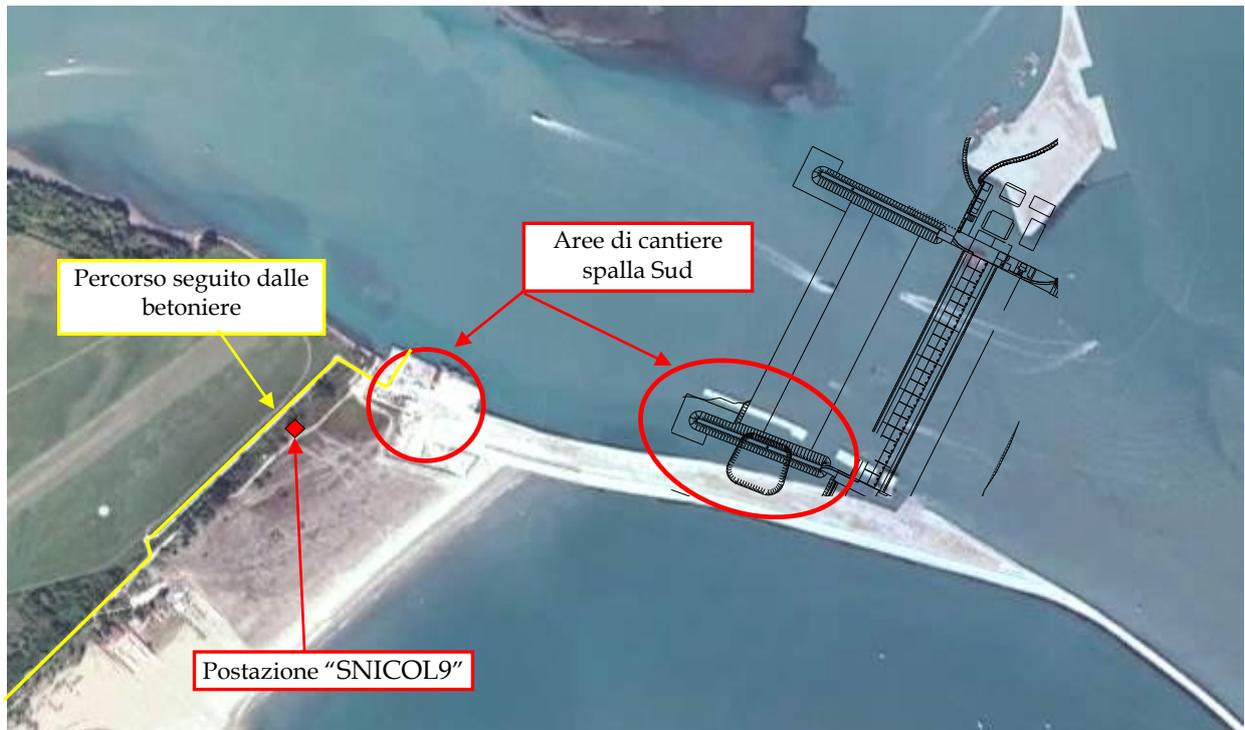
Individuazione della postazione di misura SNICOL9, delle aree di lavorazione presso il cantiere della spalla Sud, e del tragitto percorso dalle betoniere.
